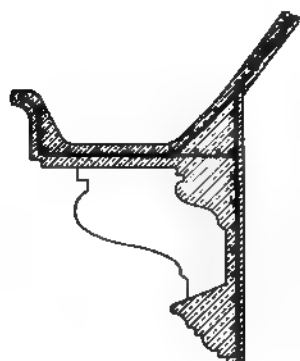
Dachrinne beim Wasserwerk Rosslau.
